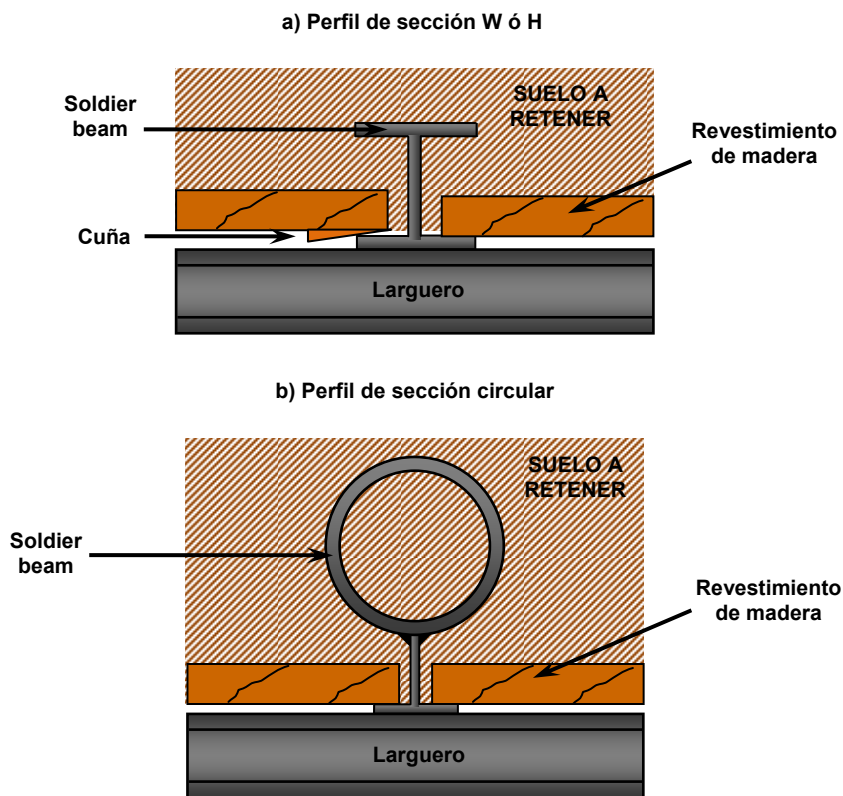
Secciones comunes para soldier beams de acero estructural.
